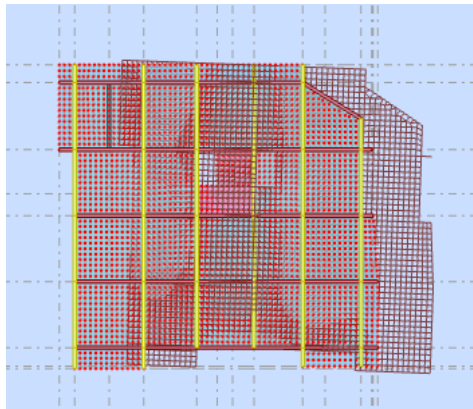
Vue en plan et en élévation de la disposition des voiles.
